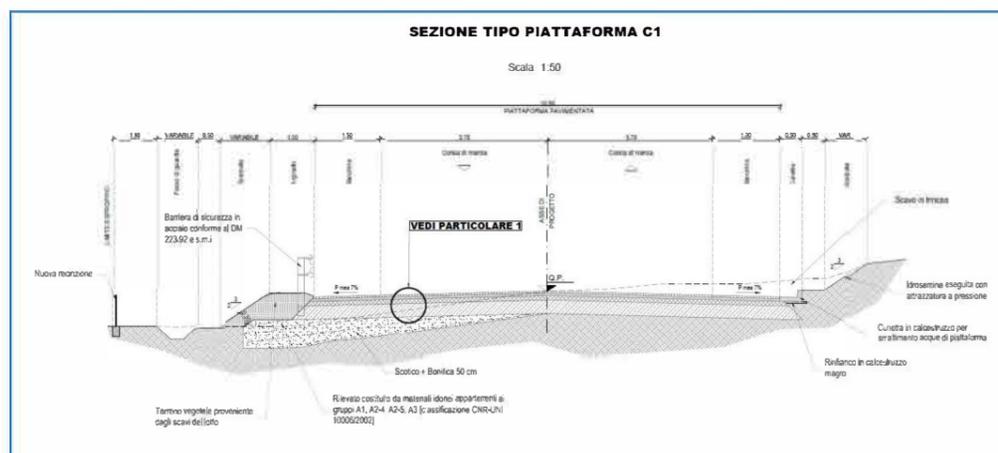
Sezione tipo della carreggiata stradale in progetto.
